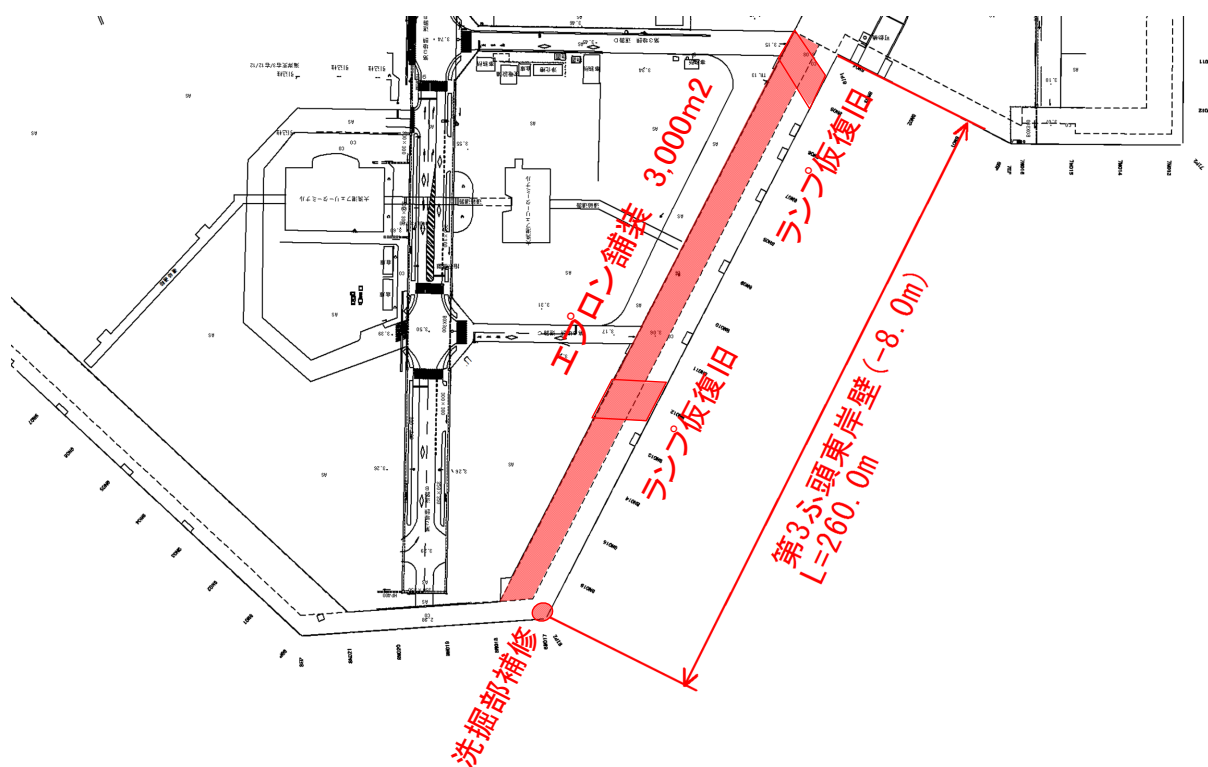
No.33 大洗港区\_第3埠頭地区東岸壁 (-8m) の平面図 (被災前)
